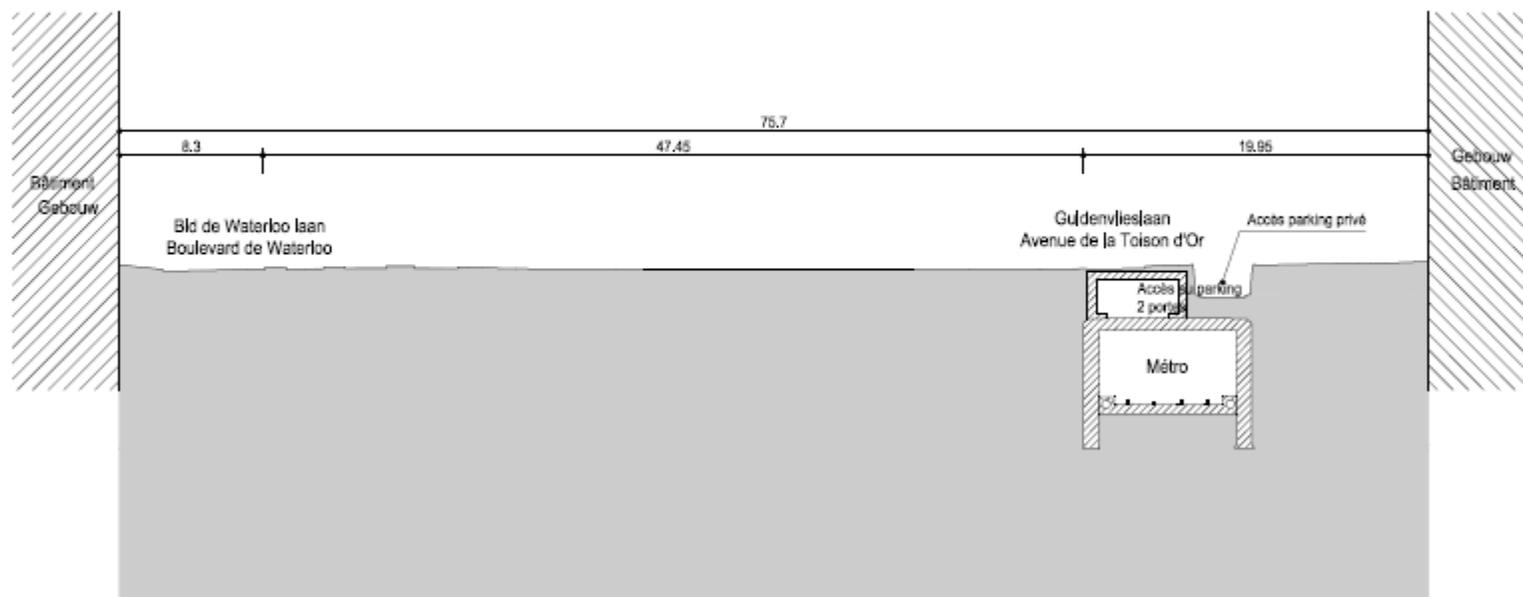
Coupe transversale 3 de la zone du projet dans la situation existante.
